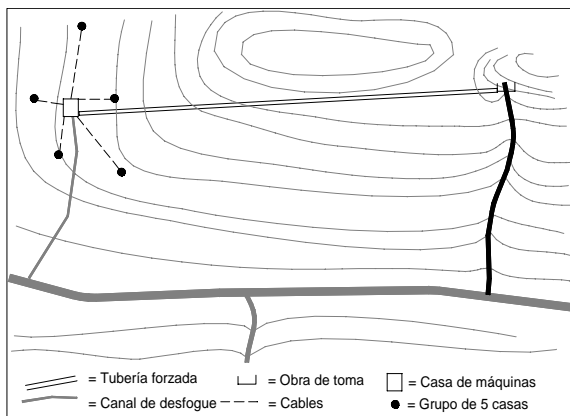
El Esquema 1 se caracteriza por una red de distribución eléctrica lo más corto posible, con un mínimo de gasto en la compra de cables. Sin embargo, la tubería forzada es larga y va a tener un costo alto.
